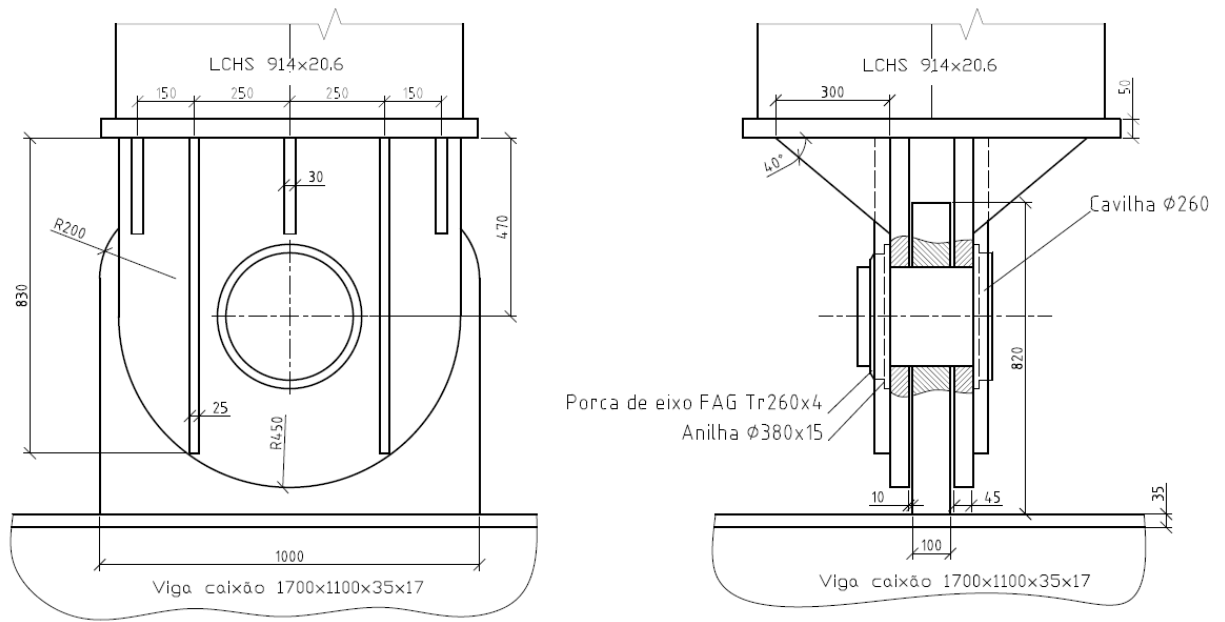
Geometria da ligação vertical da torre aos tirantes
